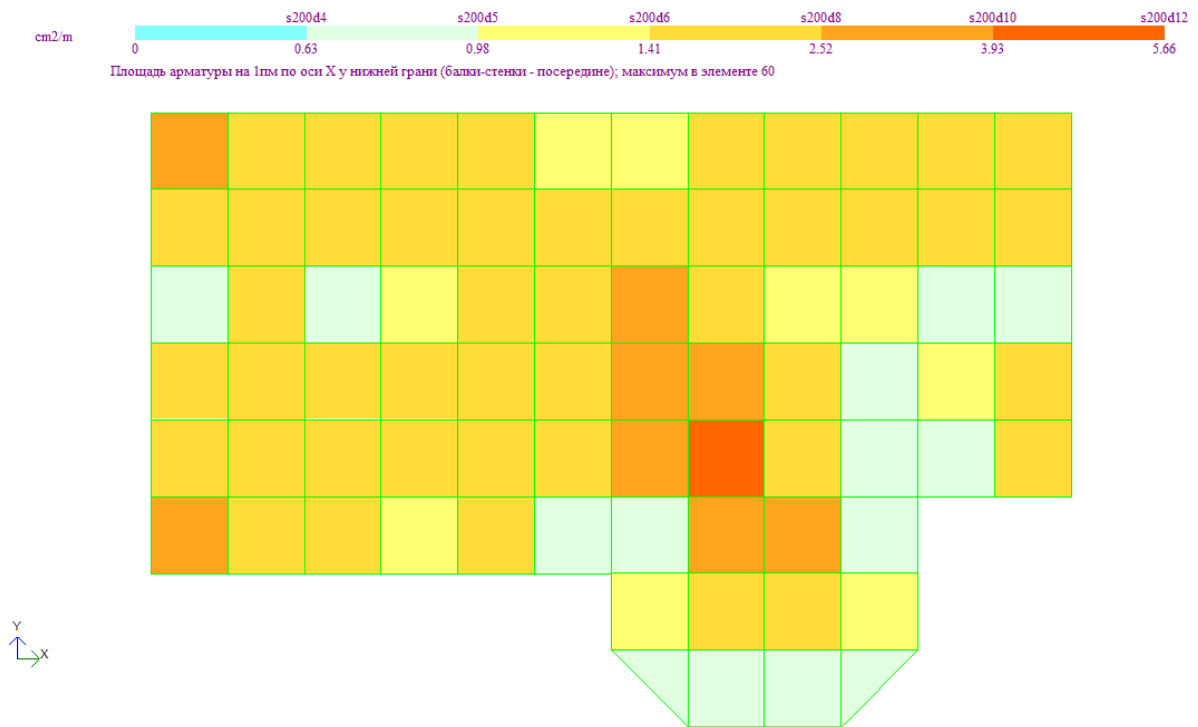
Площадь арматуры на 1 пм для монолитного участка плиты перекрытия по оси X у нижней грани
